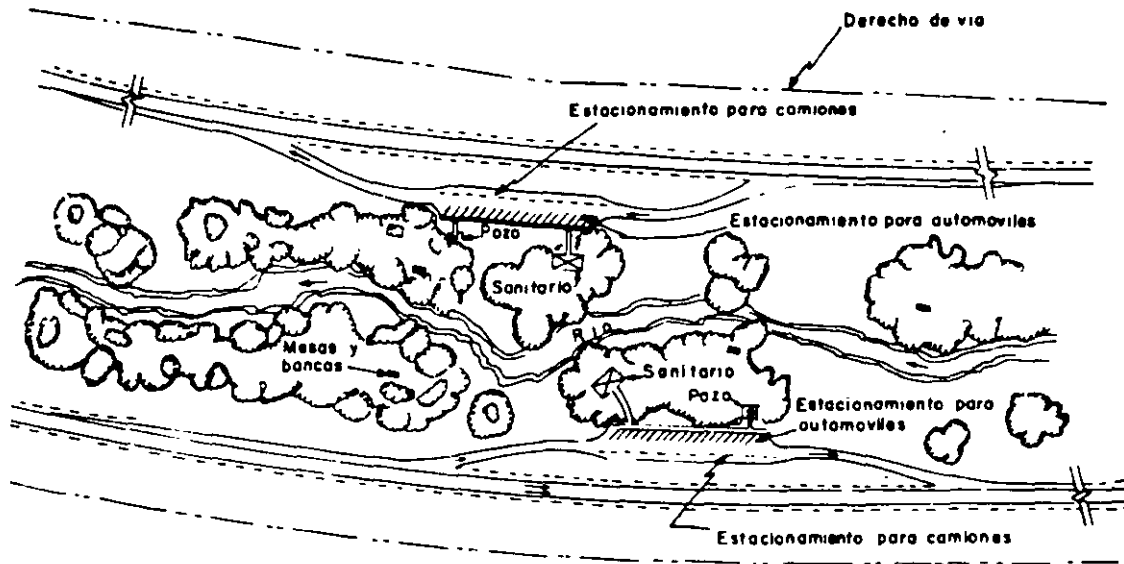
ZONA DE DESCANSO ENTRE DOS CUERPOS DE UNA AUTOPISTA
